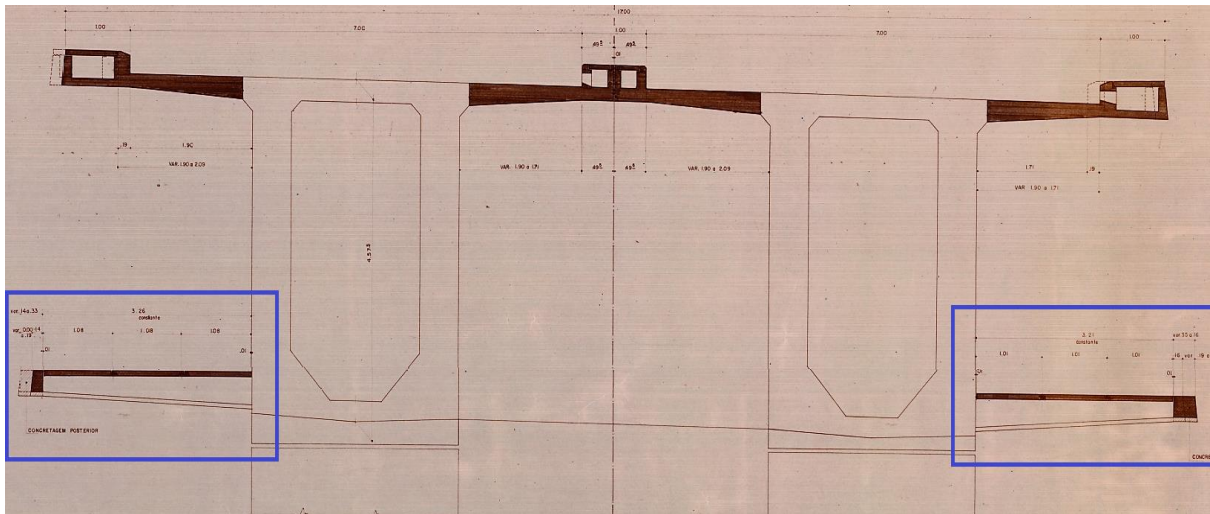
Em destaque, passeios inferiores da ponte CMS
